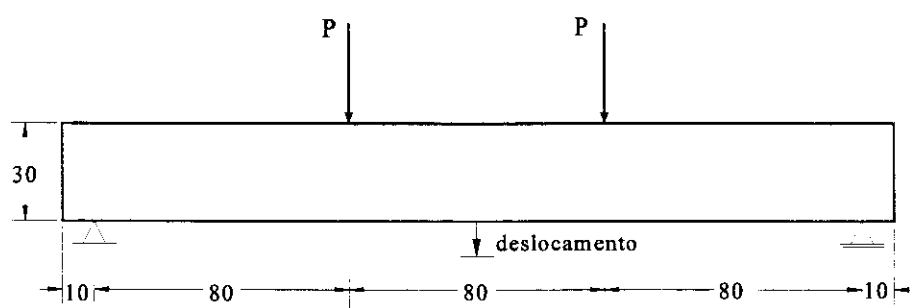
Geometria da viga ensaiada em ÁLVARES [02].
